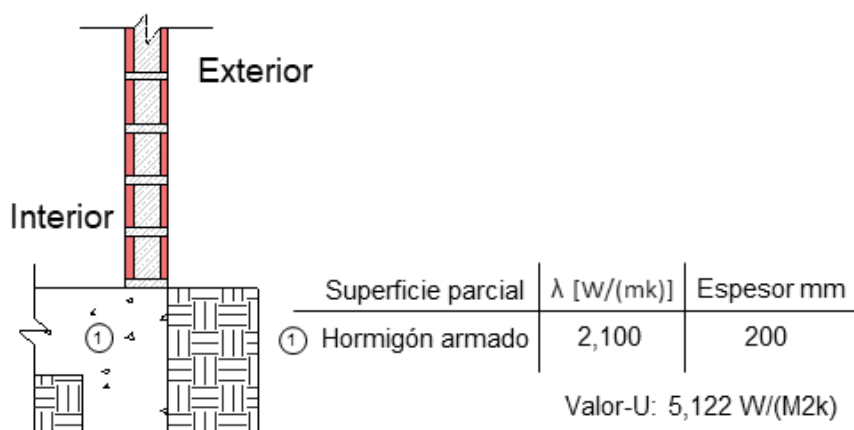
Detalle de elemento constructivo de losa de cimentación. Fuente: elaboración propia.
